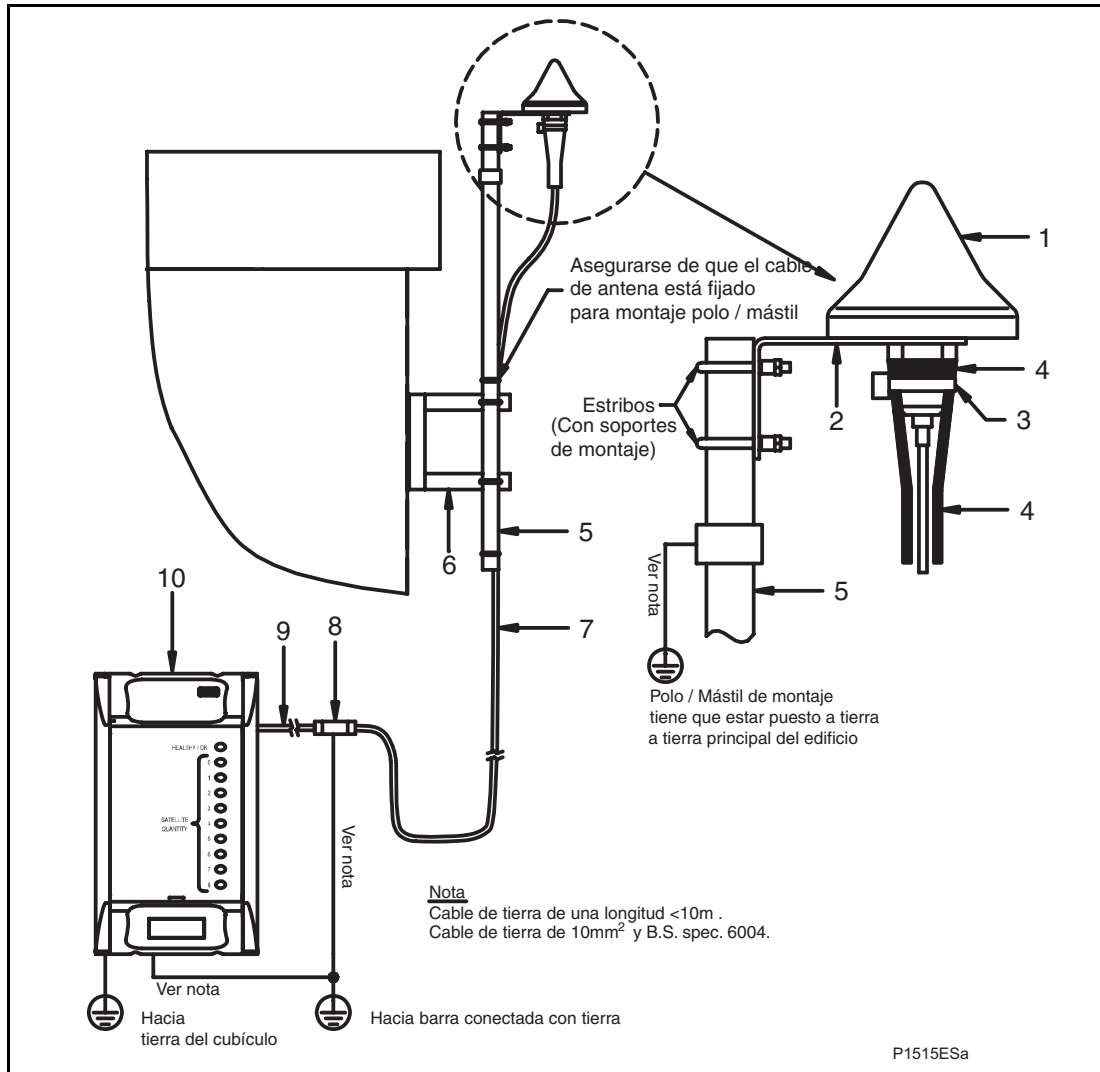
MONTAJE DEL CONJUNTO ESTÁNDAR (25 M)
